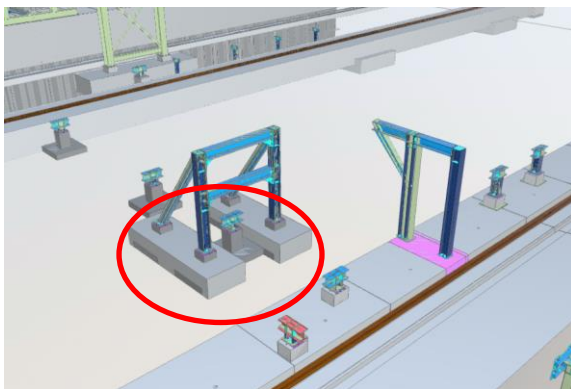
Doorsnede Cable Tower fundatieblok
